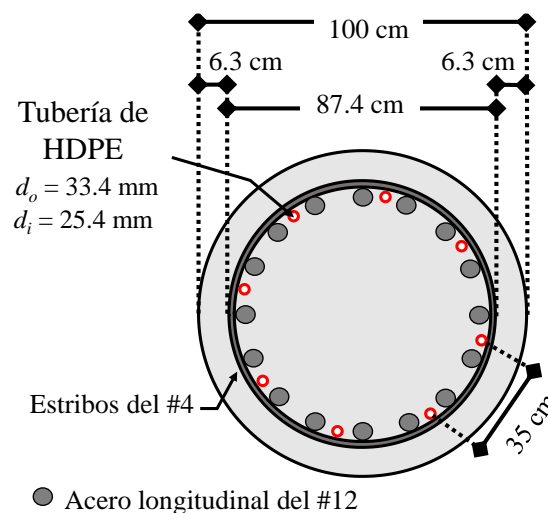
Sección transversal de las pilas de energía de 80 y 100 cm del proyecto (López-Acosta y Barba, 2022)
